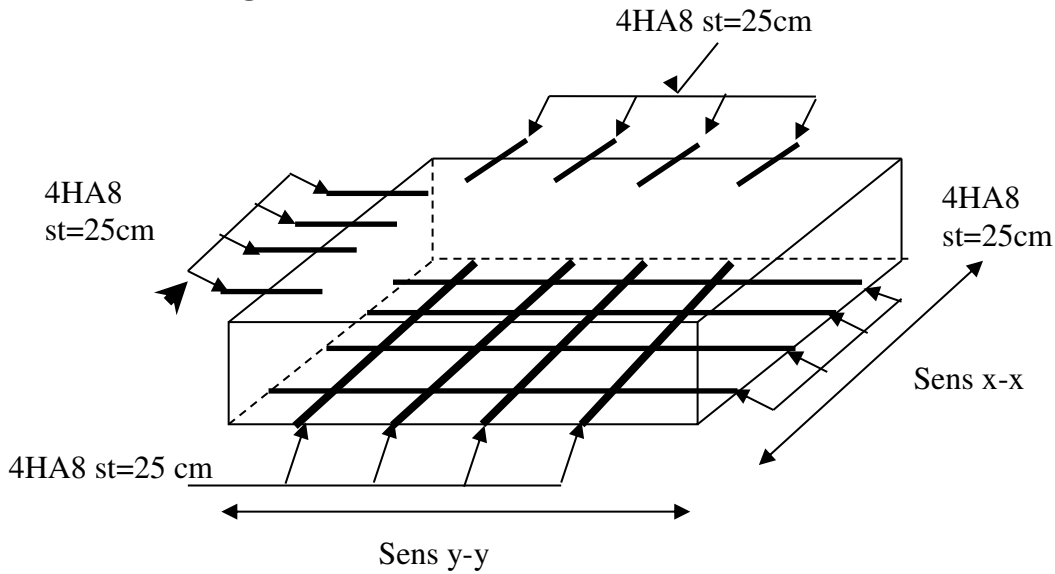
Schéma de ferrailage d'une dalle sur 4 appuis.
